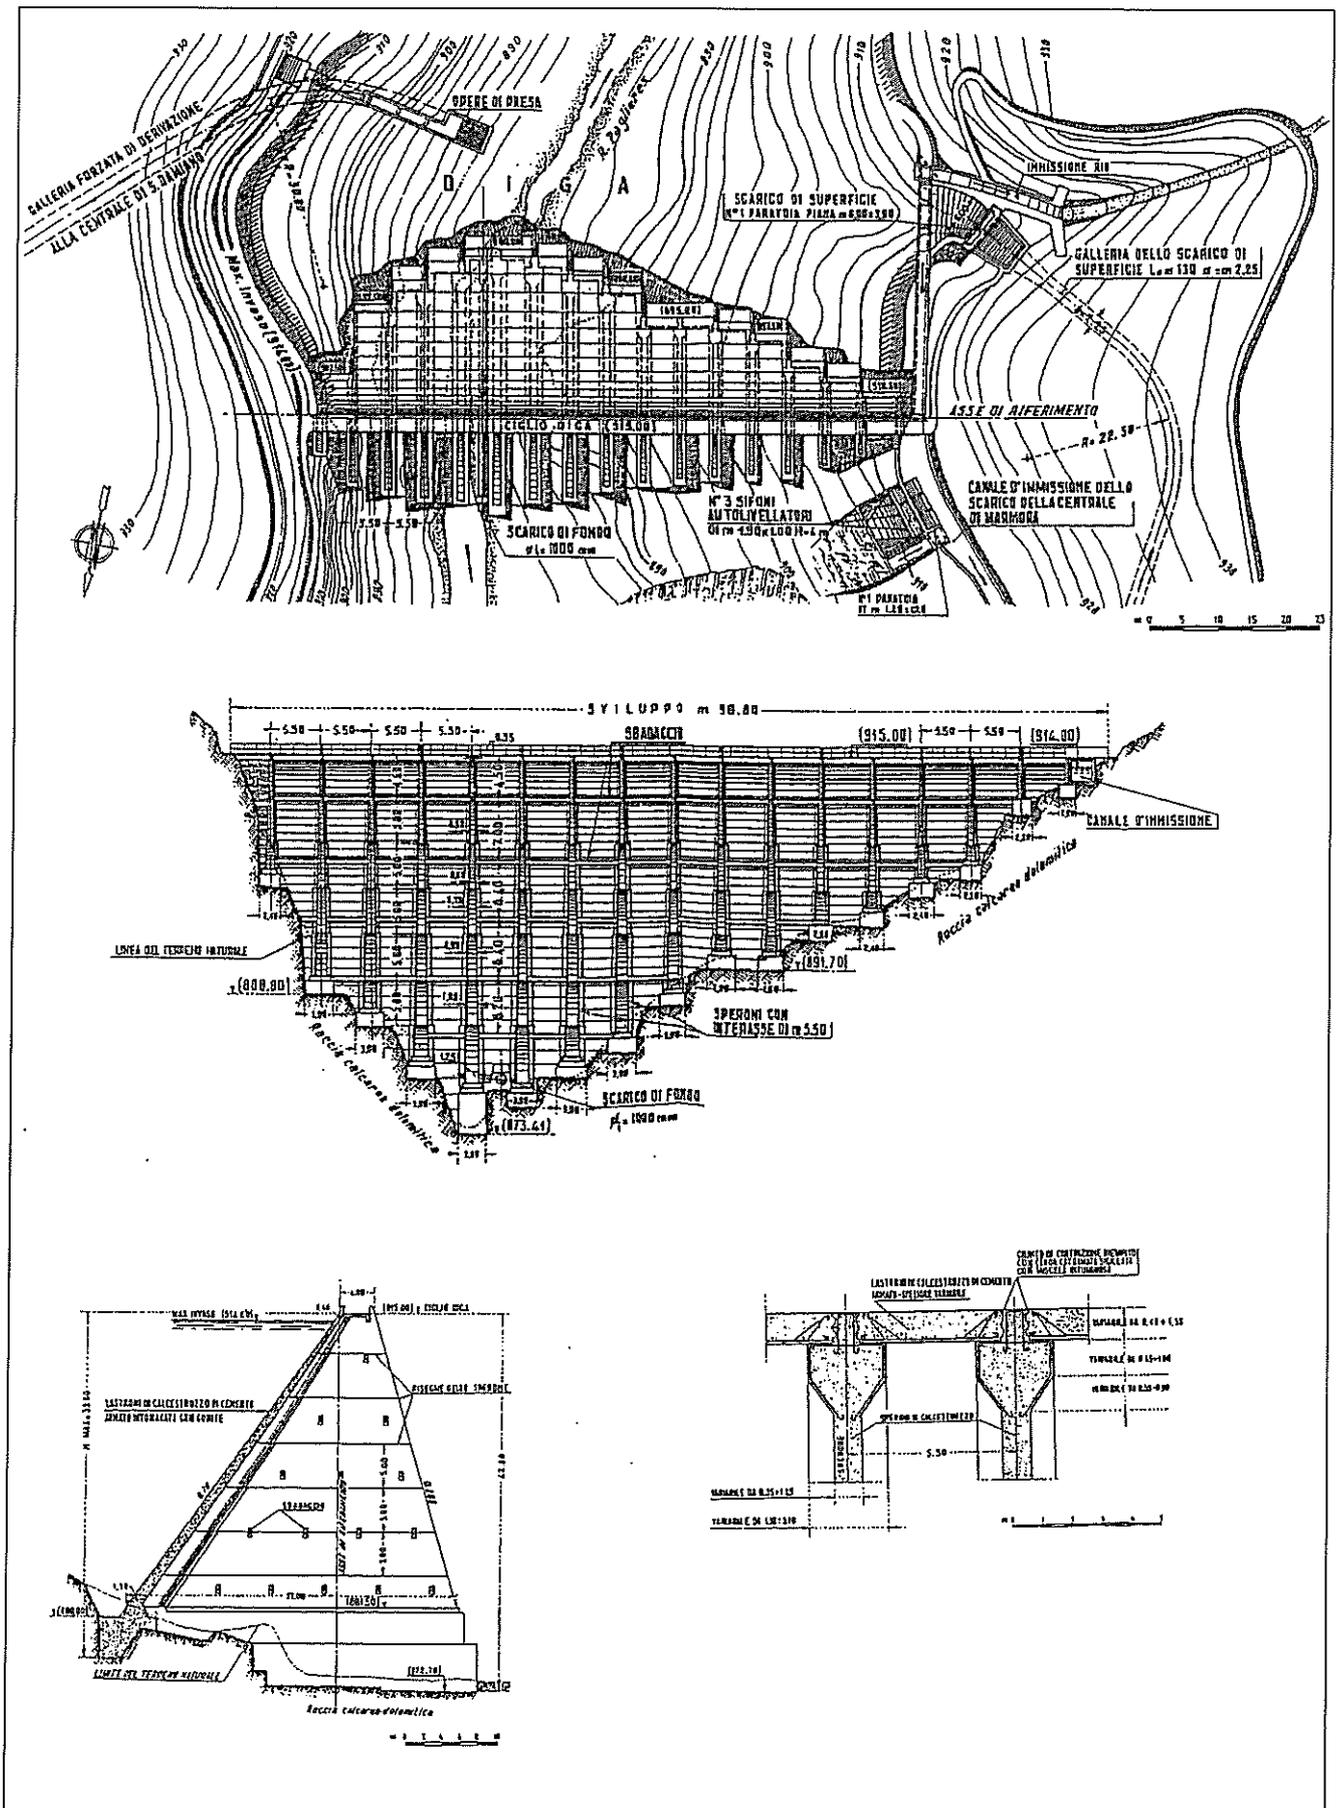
Diga di Combamala: Planimetria - Vista da valle - Sezione tipo - Sezione lastre di tenuta.
